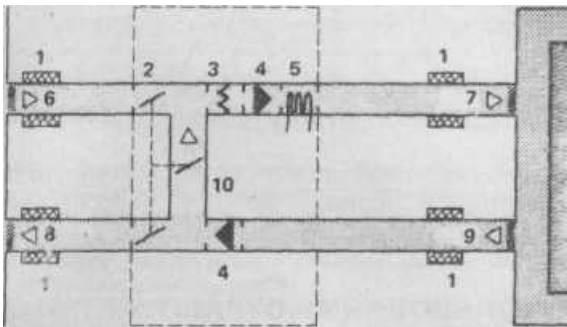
Схема циркуляционной вентиляционной системы. Расход тепла такой же, как и на рис. 5.28, однако может применяться для отопления помещения
